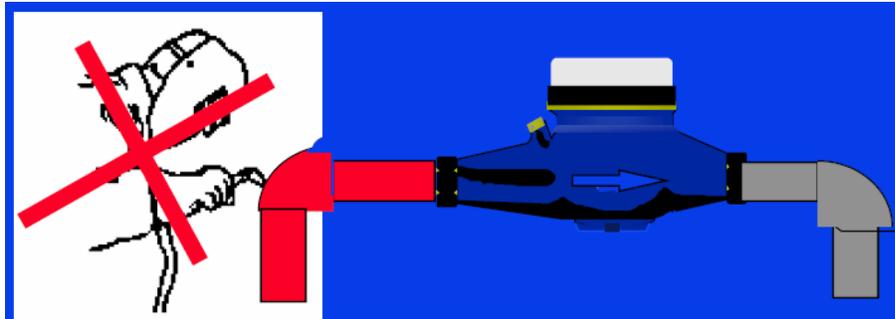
Recomendación de instalación referente a soldadura en la tubería.
